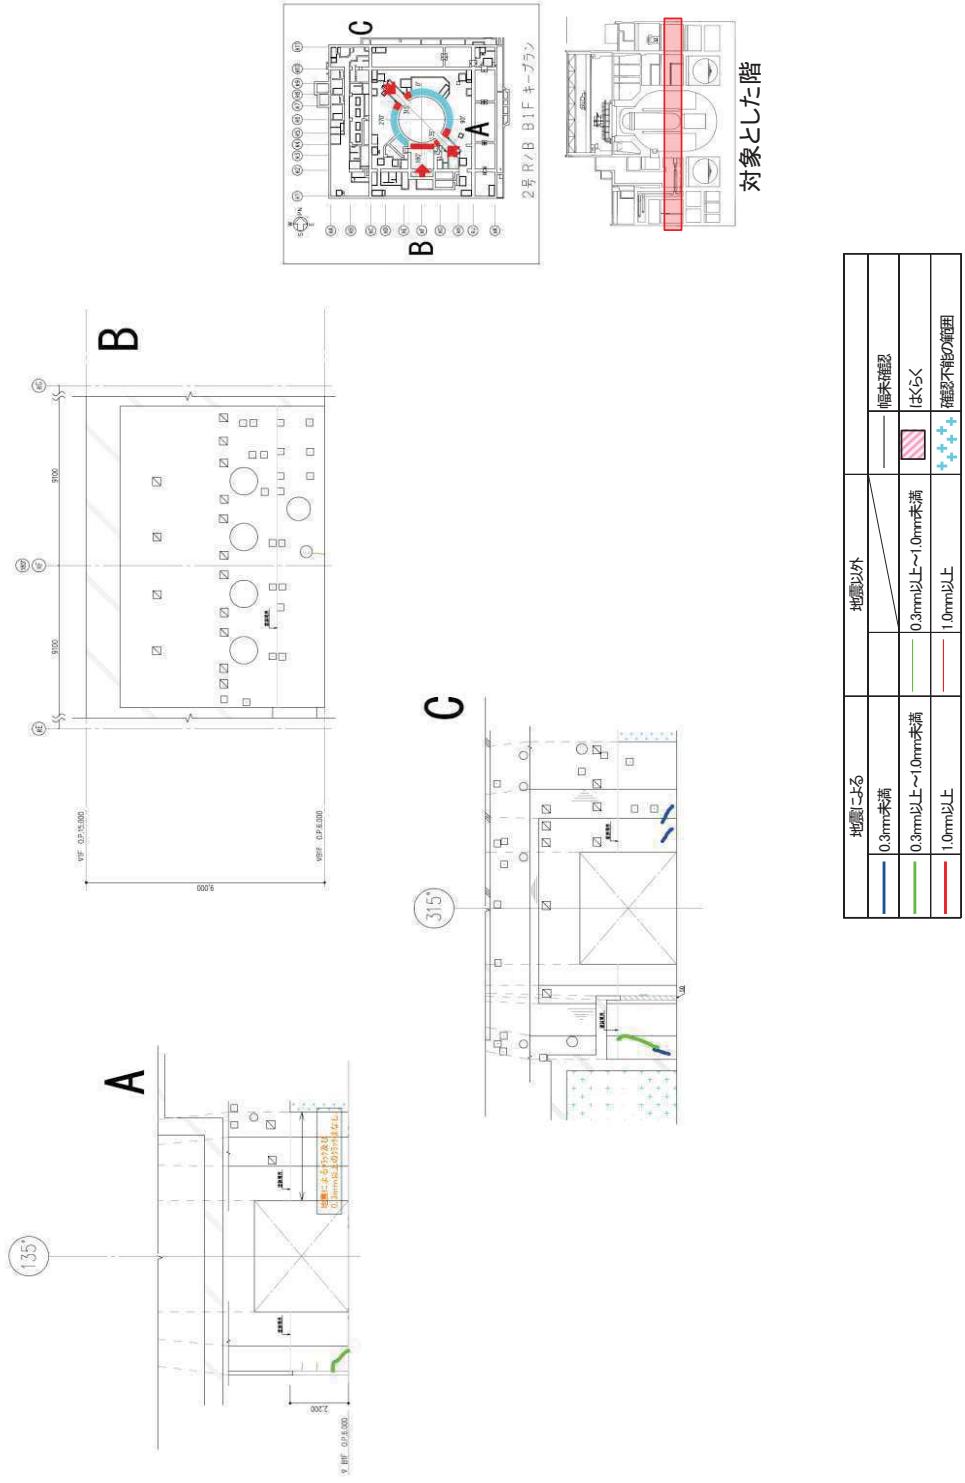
原子炉建屋のひび割れ分布 耐震壁 (28) 地下 1 階 シェル壁
